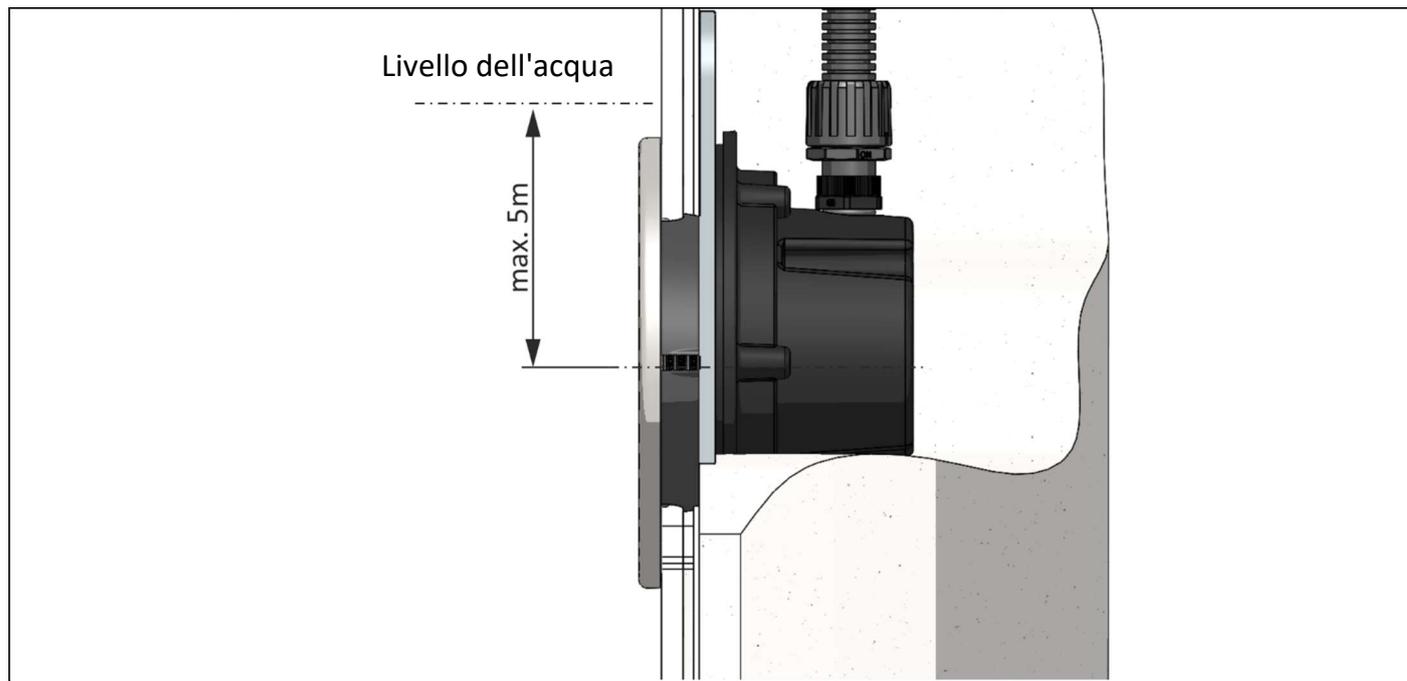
Rispettare la profondità massima di installazione ammessa!
